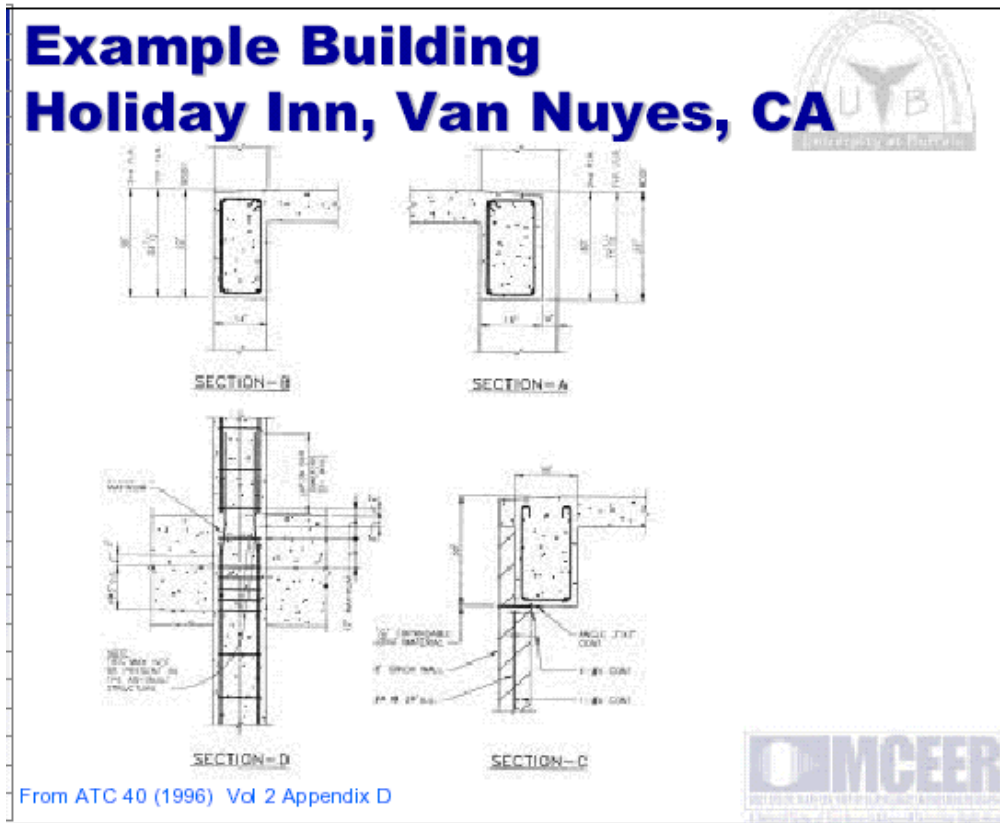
Detalle de secciones de vigas y columnas de concreto reforzado.
